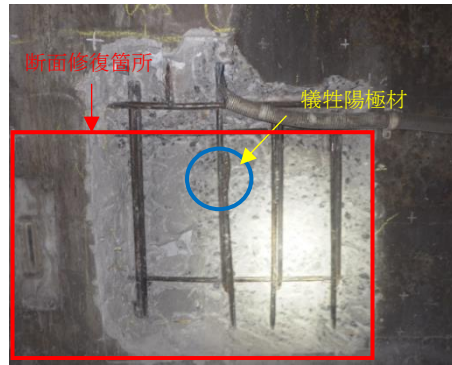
鉄筋腐食の状況 No. 11 (大島川A線 13k556m)
